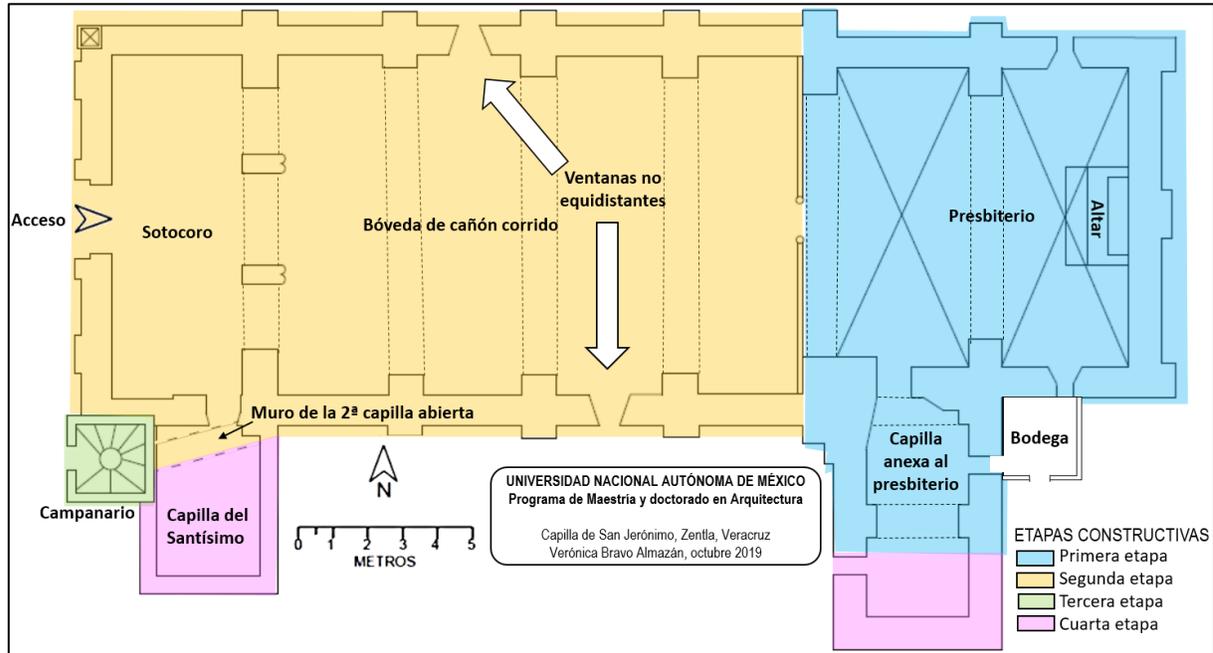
11. Planta general que muestra el uso y distribución de los espacios; además, las diversas etapas constructivas (plano de la autora).
